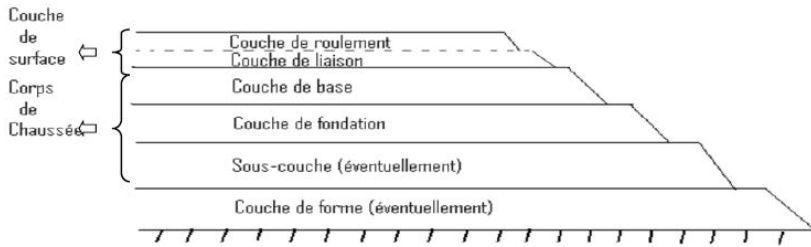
Coupe type montrant les différentes couches d'une chaussée routière (LCPC, SETRA, 1998).
